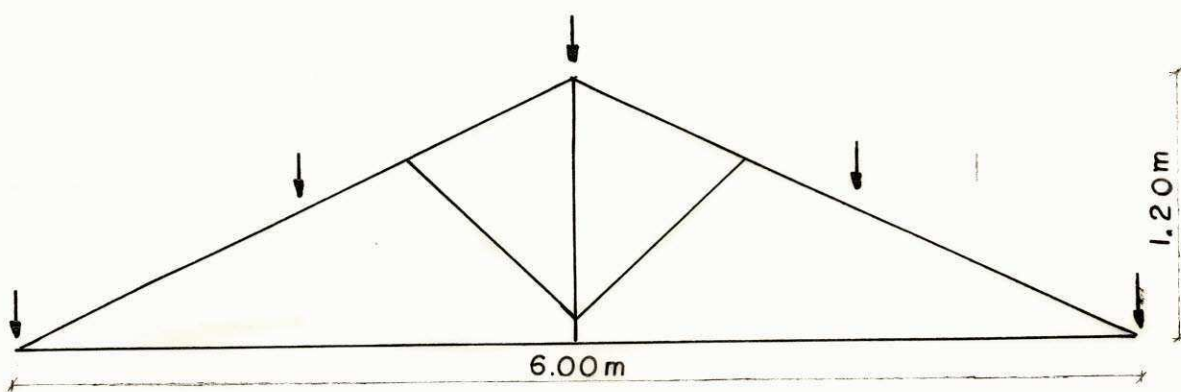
EST. TRELIÇADA - CAMPAL ESC.: 1 : 40
